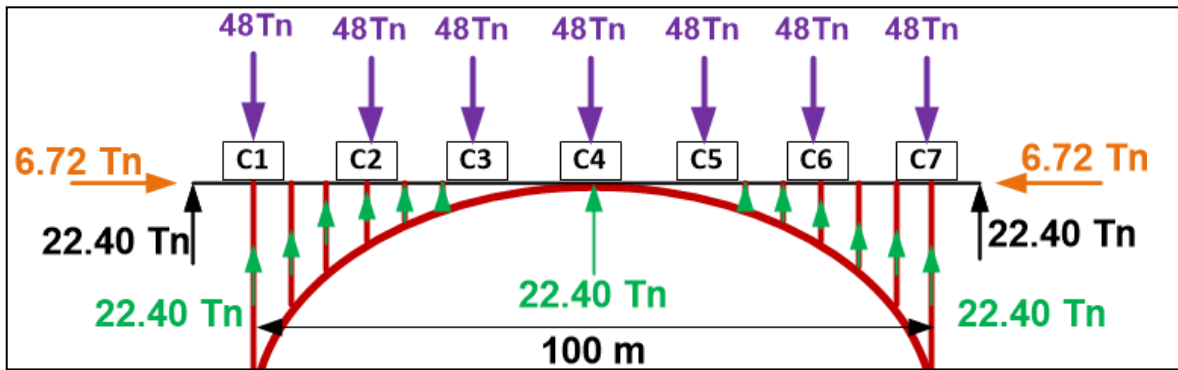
Cargas vivas de 48 Tn distribuidas en el puente metálico
